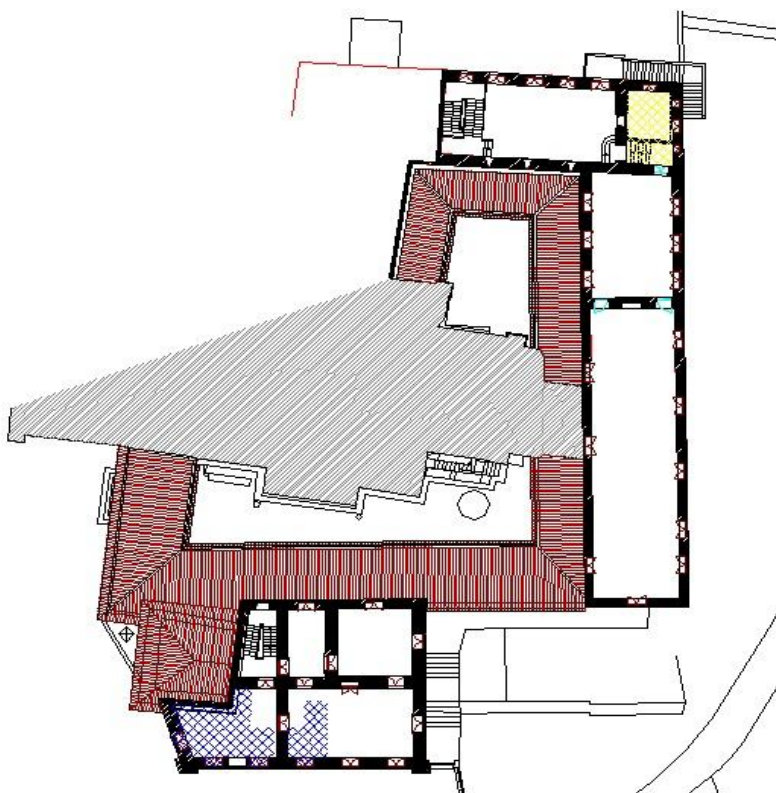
Marcação dos pavimentos do 2ºAndar. (Sem escala)
